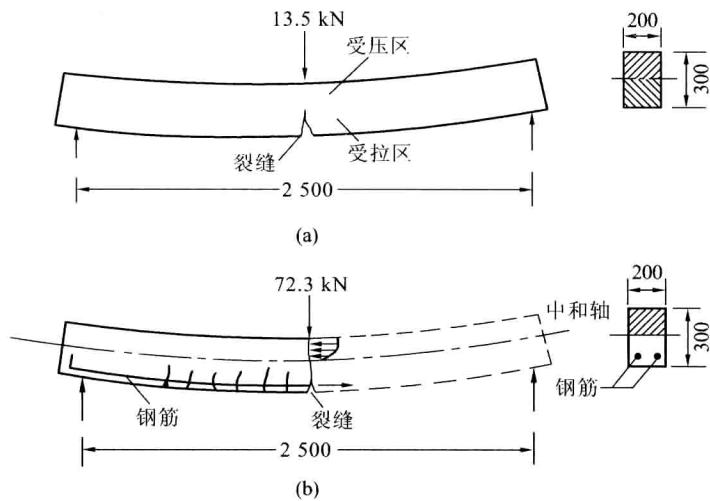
混凝土及钢筋混凝土简支梁的承载力
